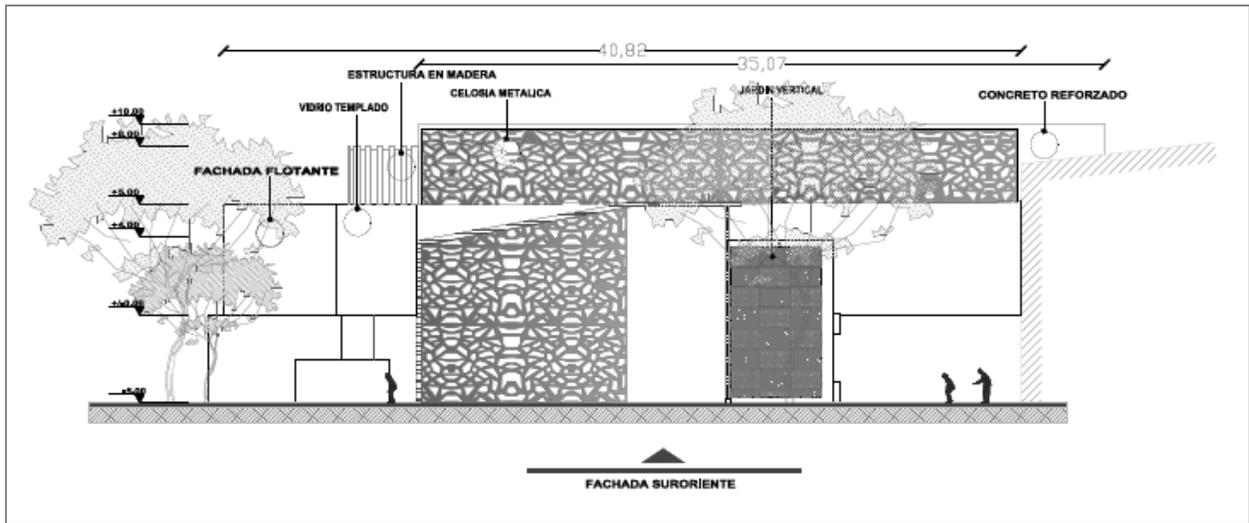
Fachada Suroriente Edificio 2 (Rubiano, 2020)
